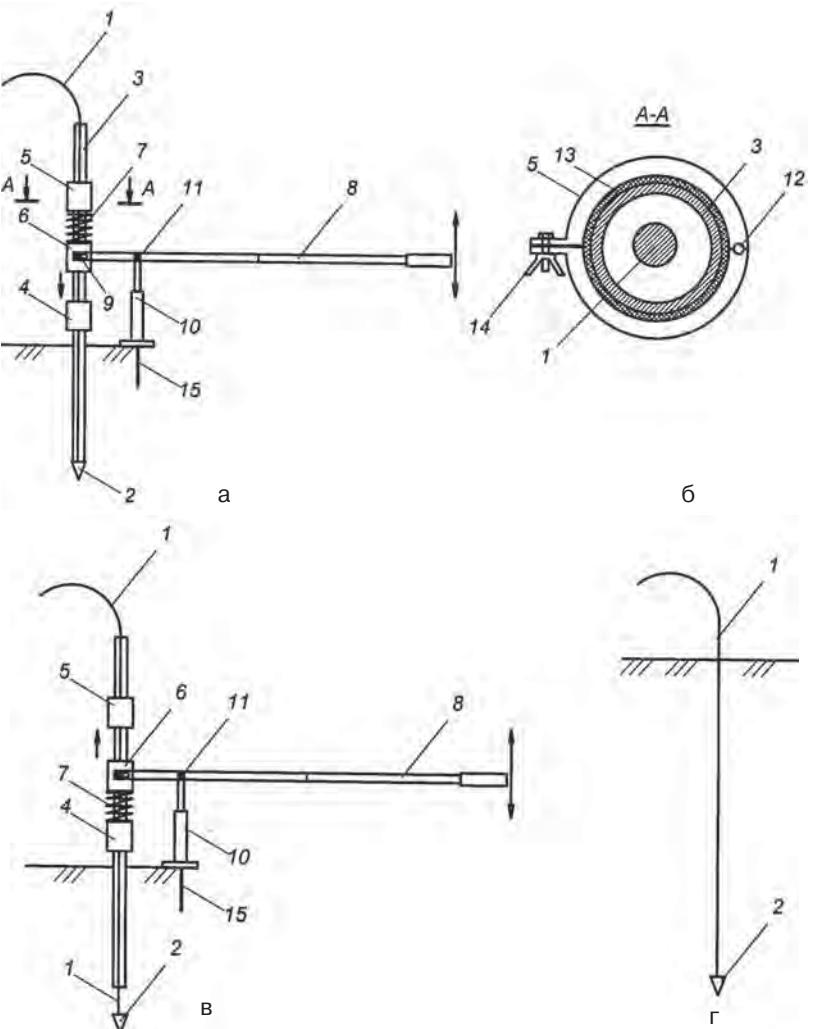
Устройство для установки проволочных анкеров с помощью забивки направляющей штанги:
